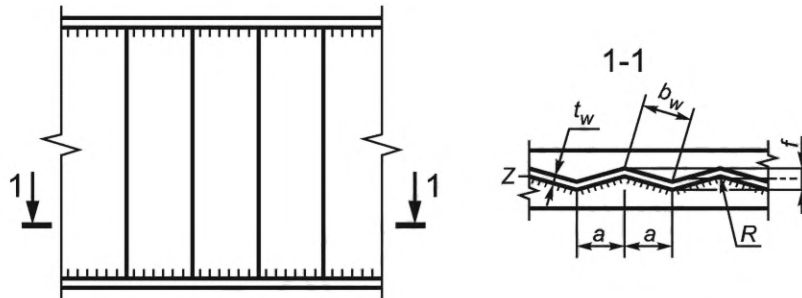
Общий вид сварного двутавра с треугольной поперечно-гофрированной стенкой и поясами из плоского листа
